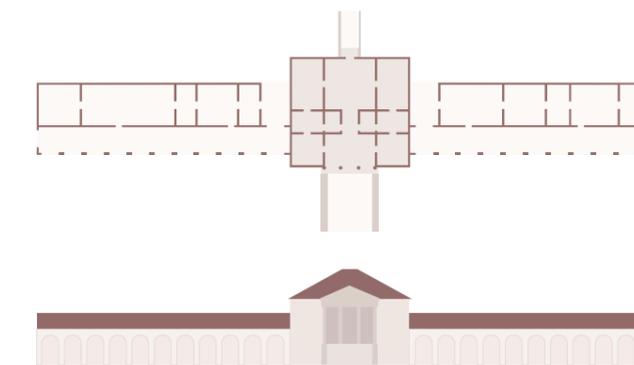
Pianta e prospetto principale del modello di Villa in linea
